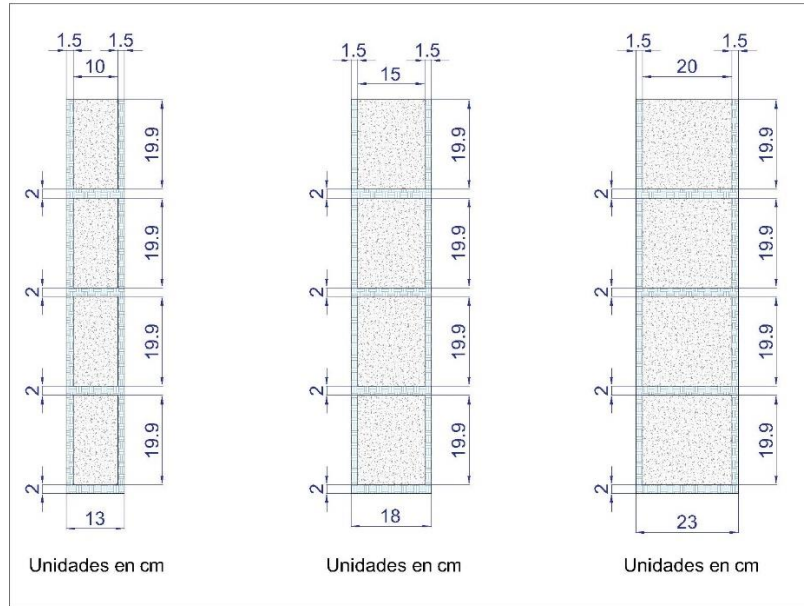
Unidad de análisis para mampostería de bloque de hormigón prensado de 10, 15 y 20 cm
